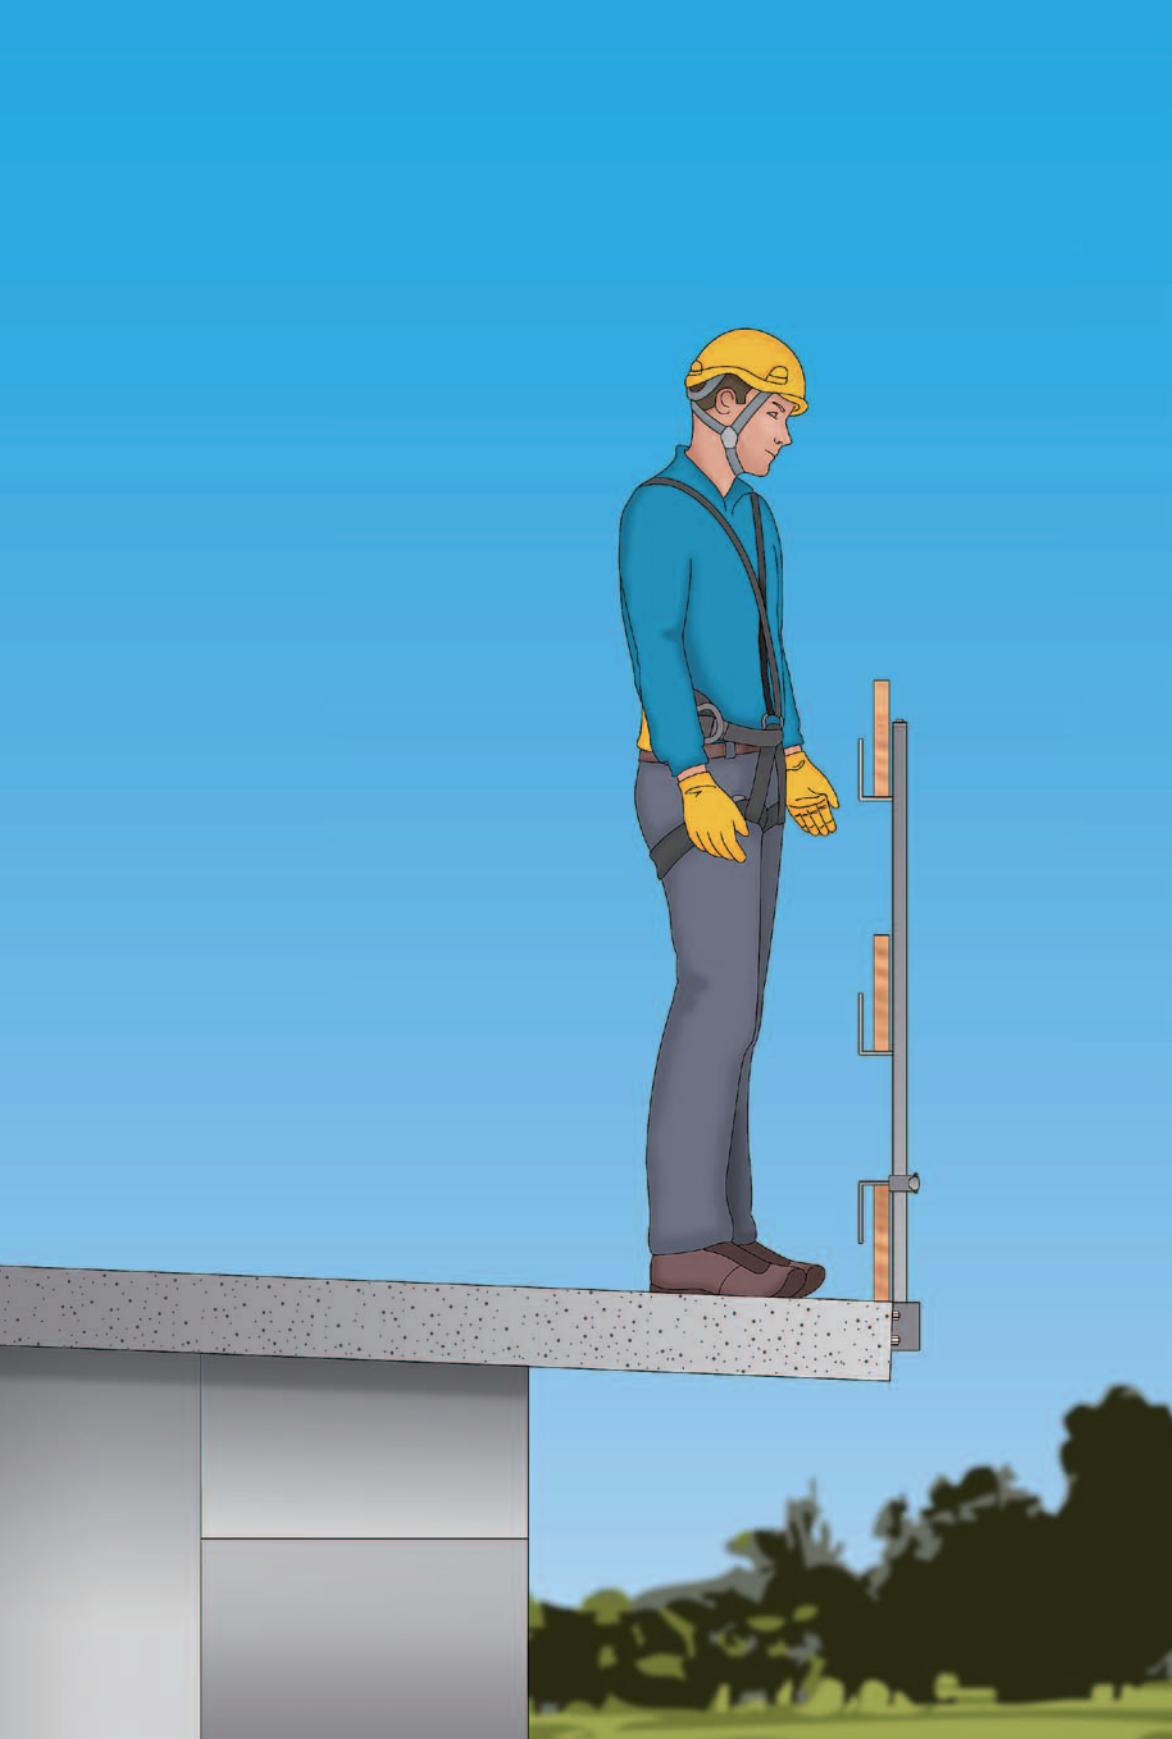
Parapetto provvisorio con gancio sottocoppo
